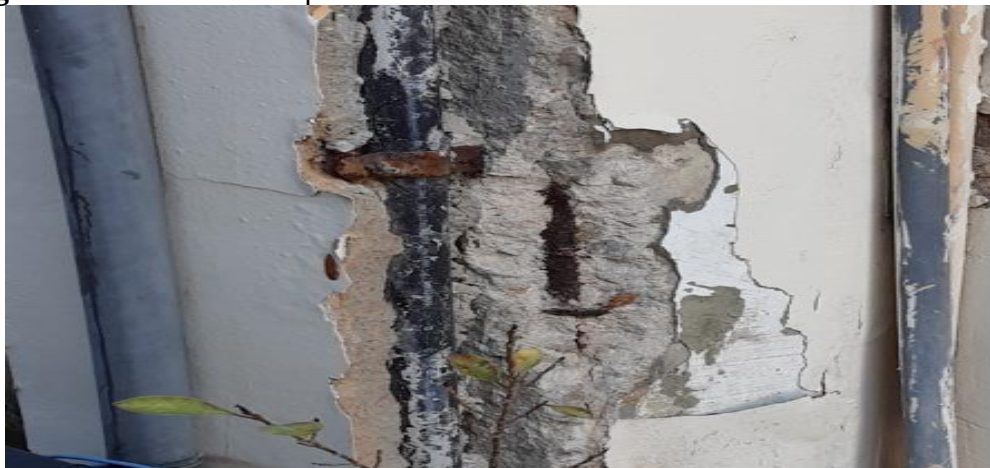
Armaduras expostas e destacamento do concreto de cobrimento.
